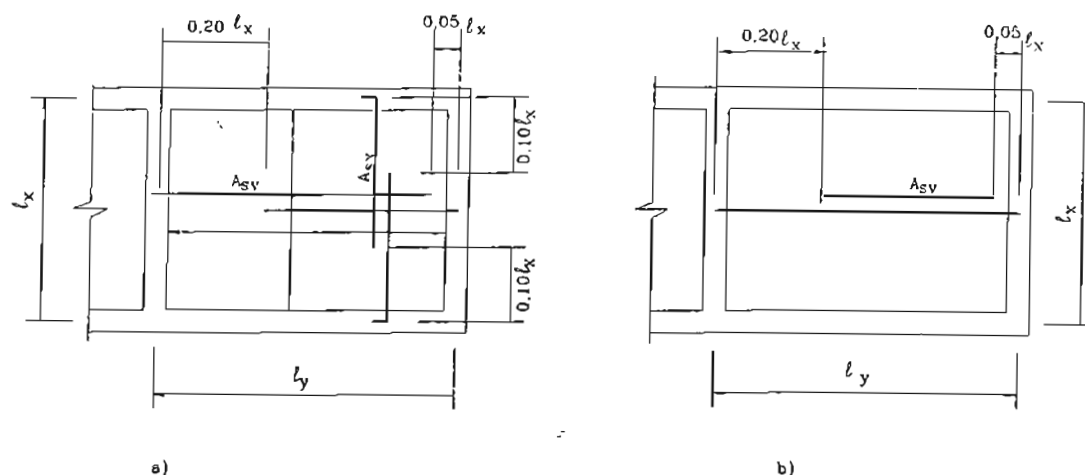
Comprimento das barras longitudinais para vão extremo de laje contínua
